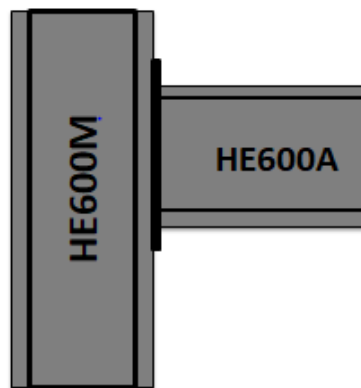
5: Assemblage poteau poutre boulonnée par platine d'extrémité
